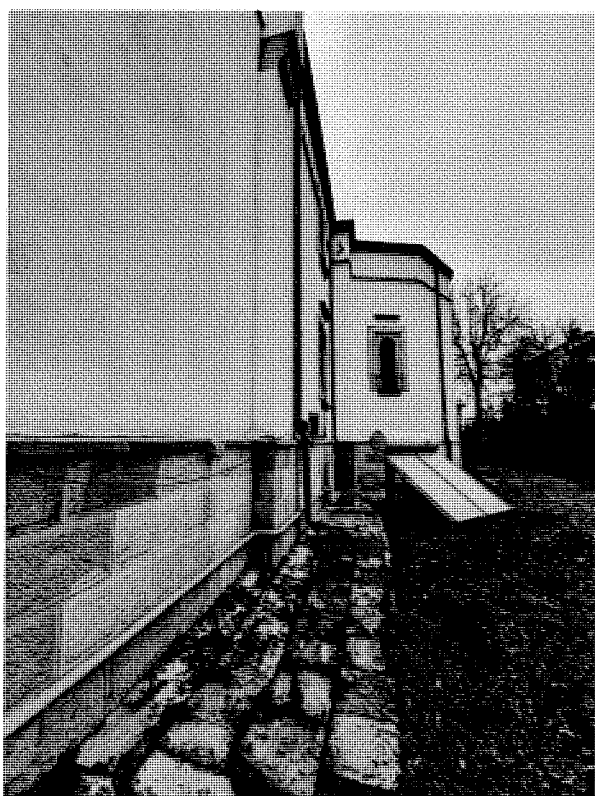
Trotuar neetanș cu posibilități de pătrundere a apelor meteorice
